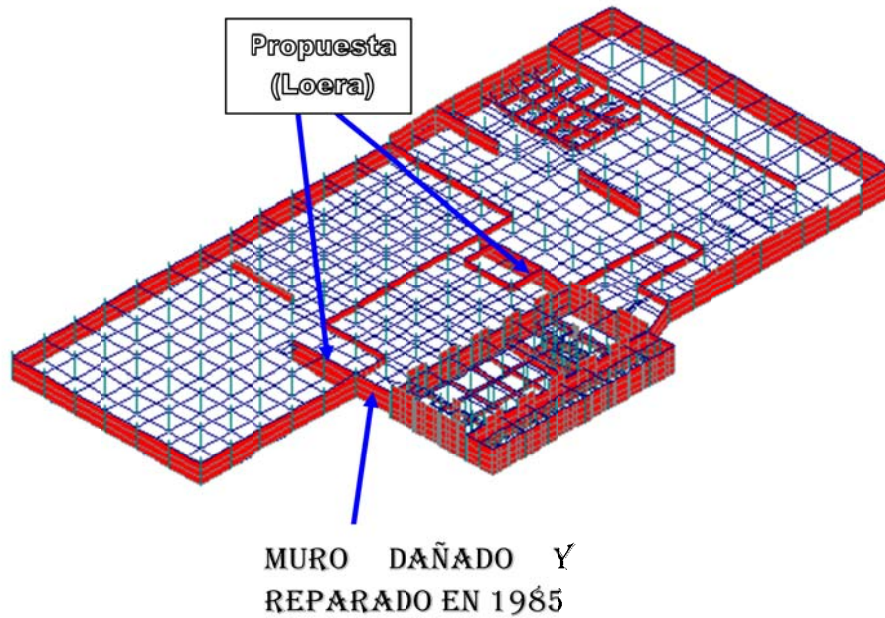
Vista en planta de la ubicación de los nuevos muros de concreto reforzado (propuesta de S. Loera) en la continuación de los ejes 6 y 12 de la Torre Mayor
